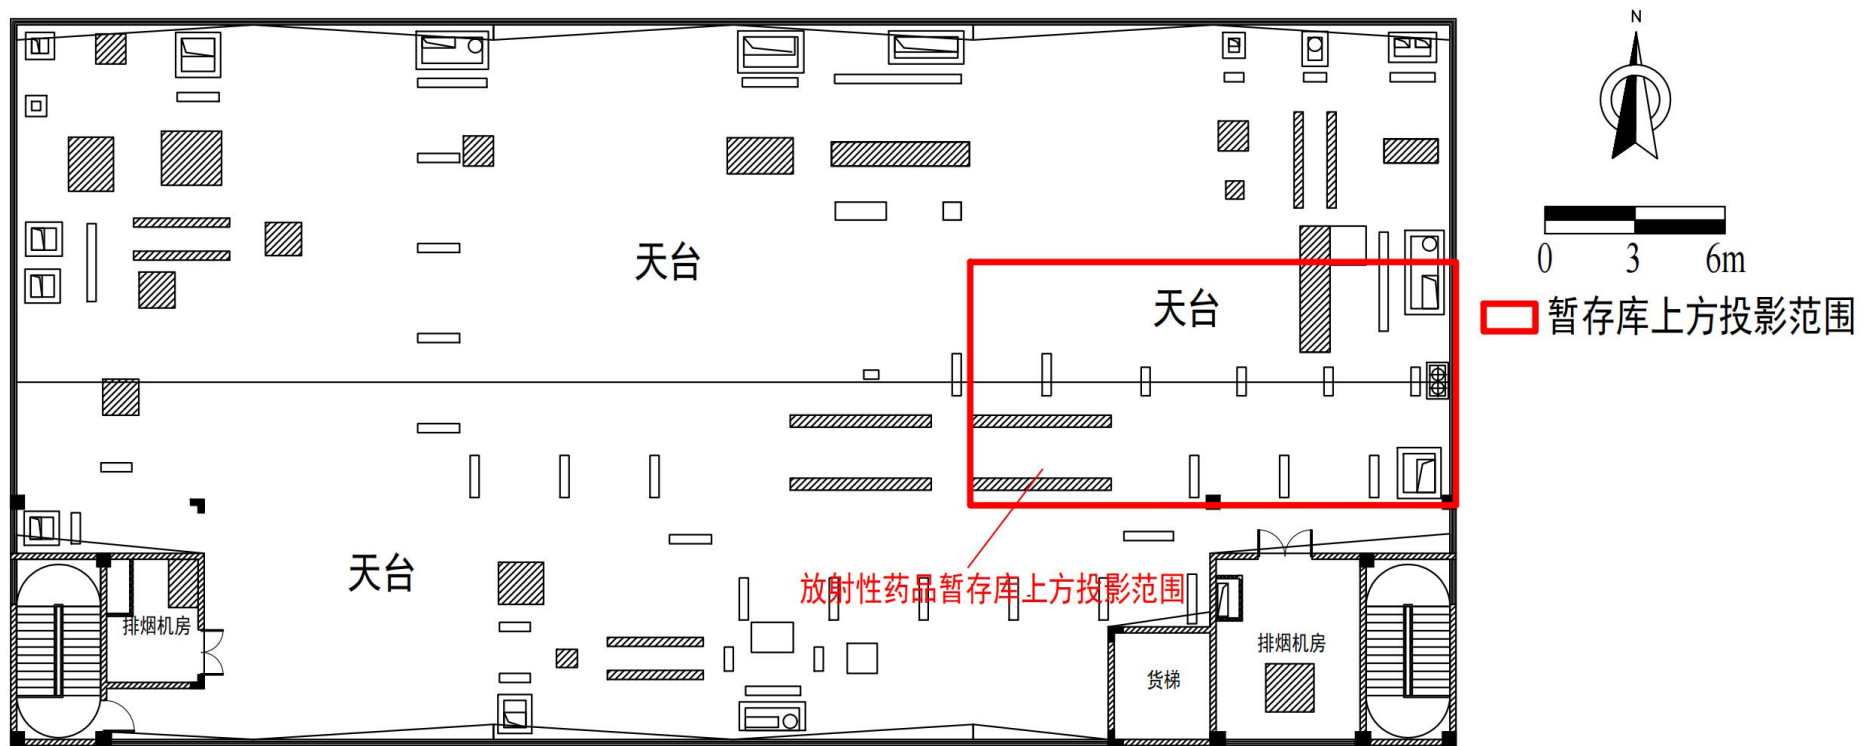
原子高科公司放射性药品暂存库上方楼层（天台）平面布置图
